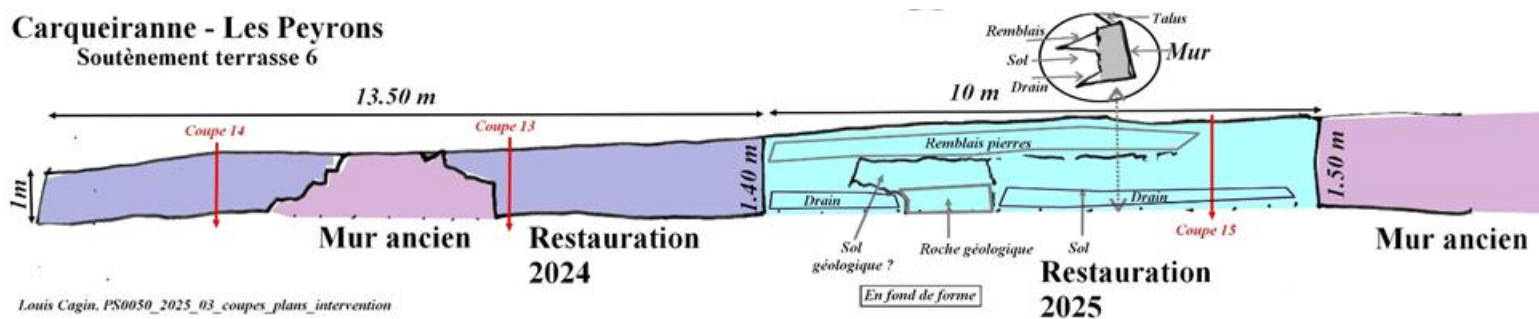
élévation du mur de soutènement de la terrasse 6 (section Nord)
